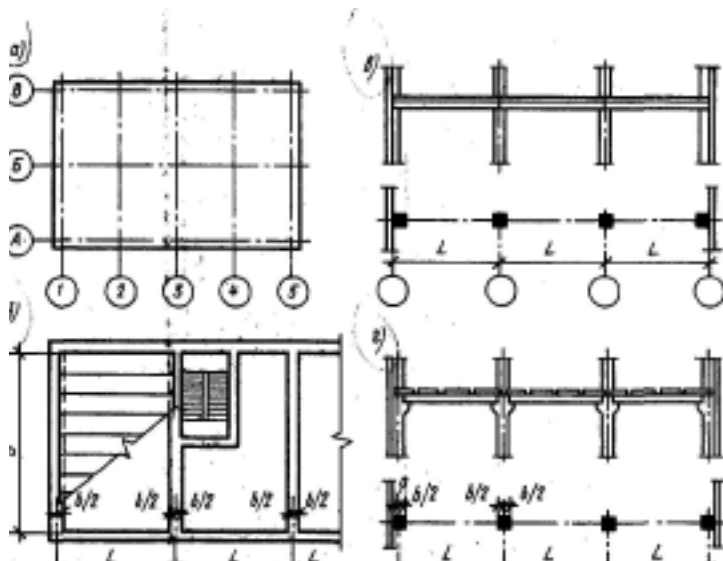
Маркировка координационных (разбивочных) осей и привязка конструкций:
